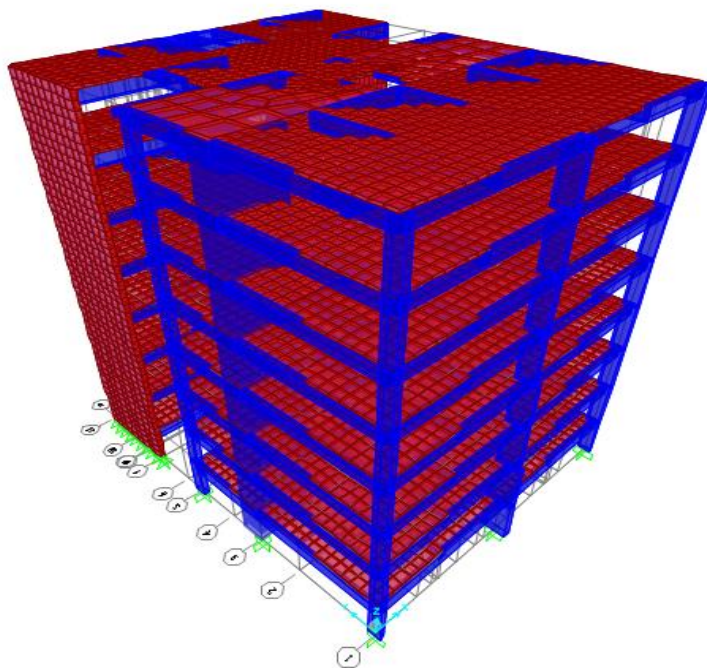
Modelamiento estructural de la edificación. Fuente propia
